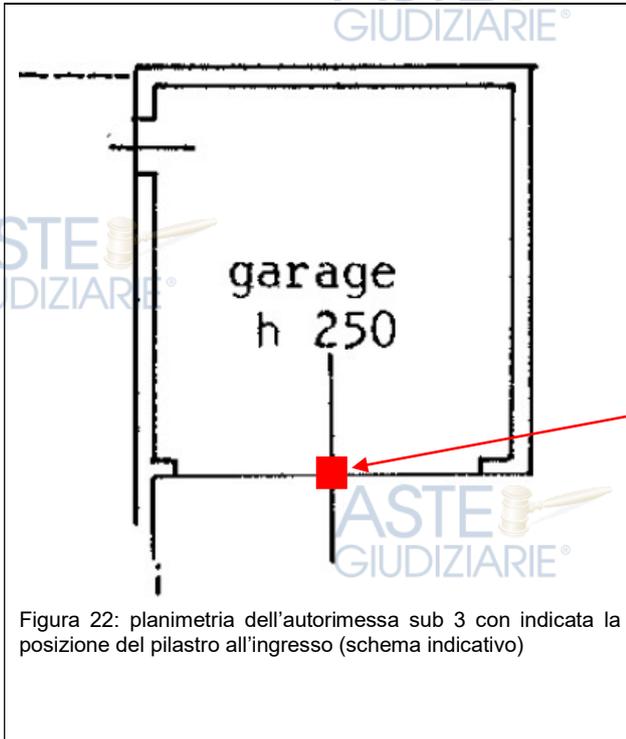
planimetria dell'autorimessa sub 3 con indicata la posizione del pilastro all'ingresso (schema indicativo)
